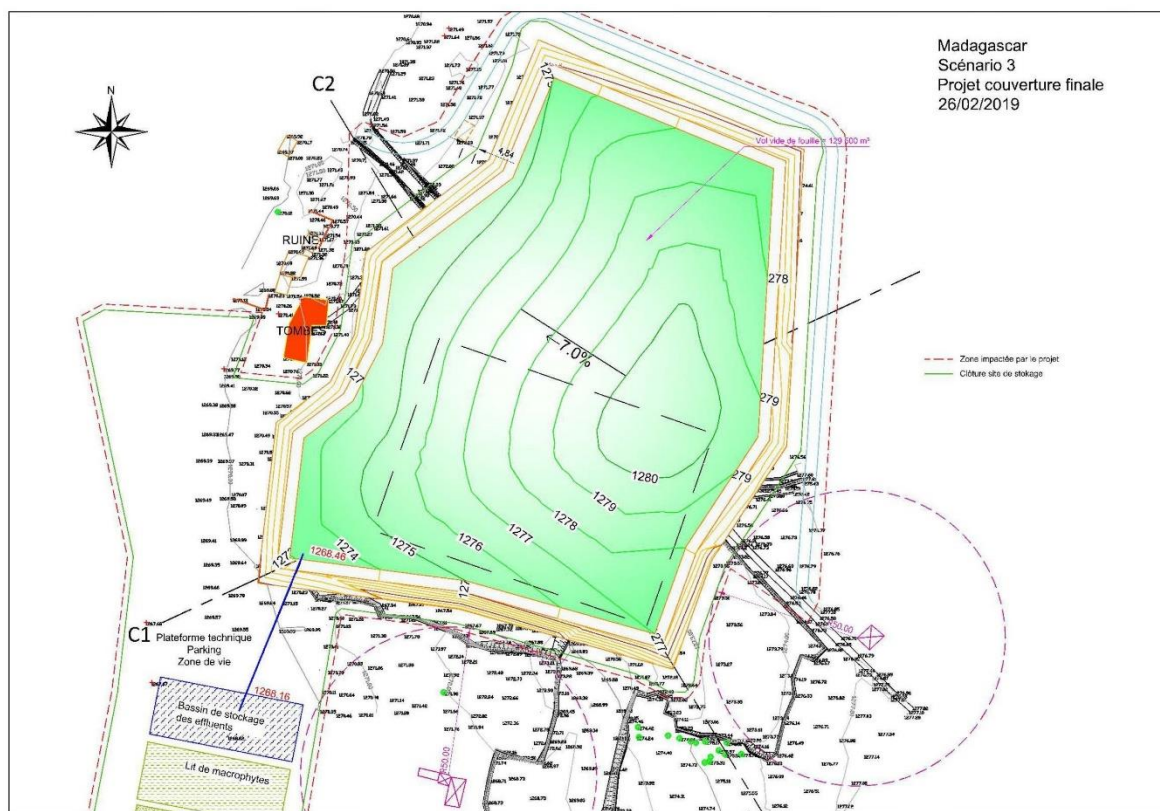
Plan de la couverture finale du casier de stockage des boues
